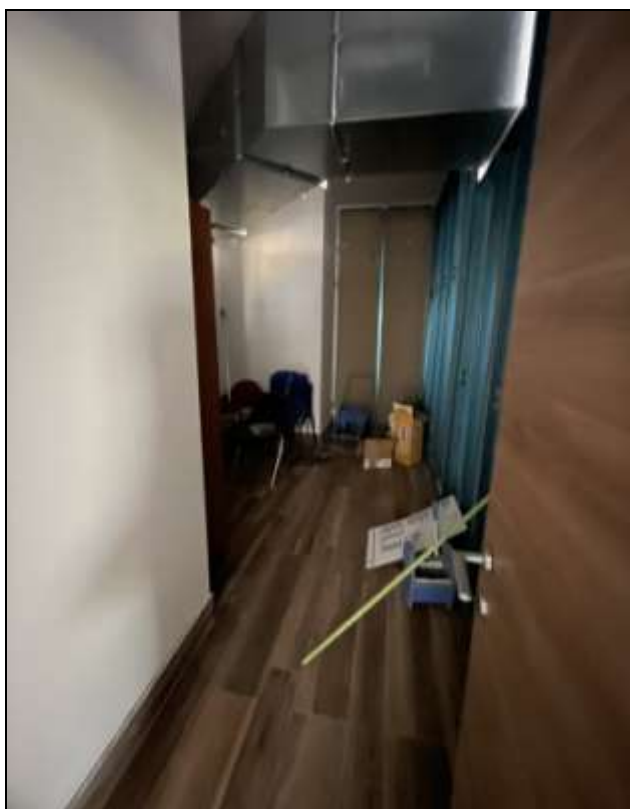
" – PIANO TERRA – Locali Accessori dell' Area Vendita-Somministrazione
